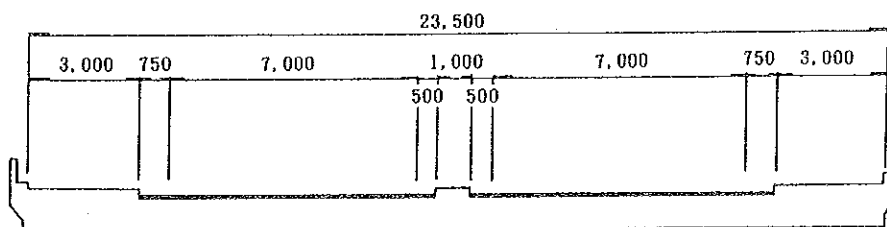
Profil en travers standard du pont ELENKESA
